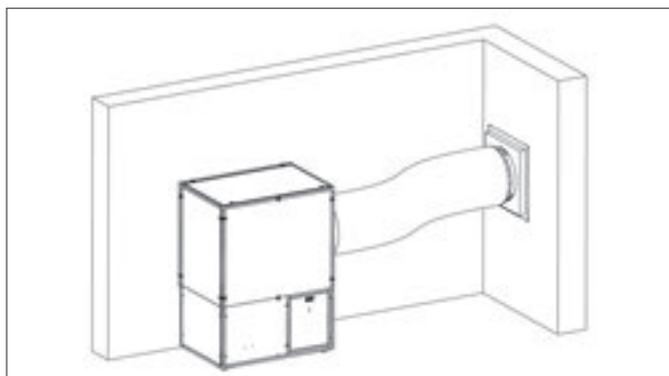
Installazione con tubo flessibile – Variante 1
